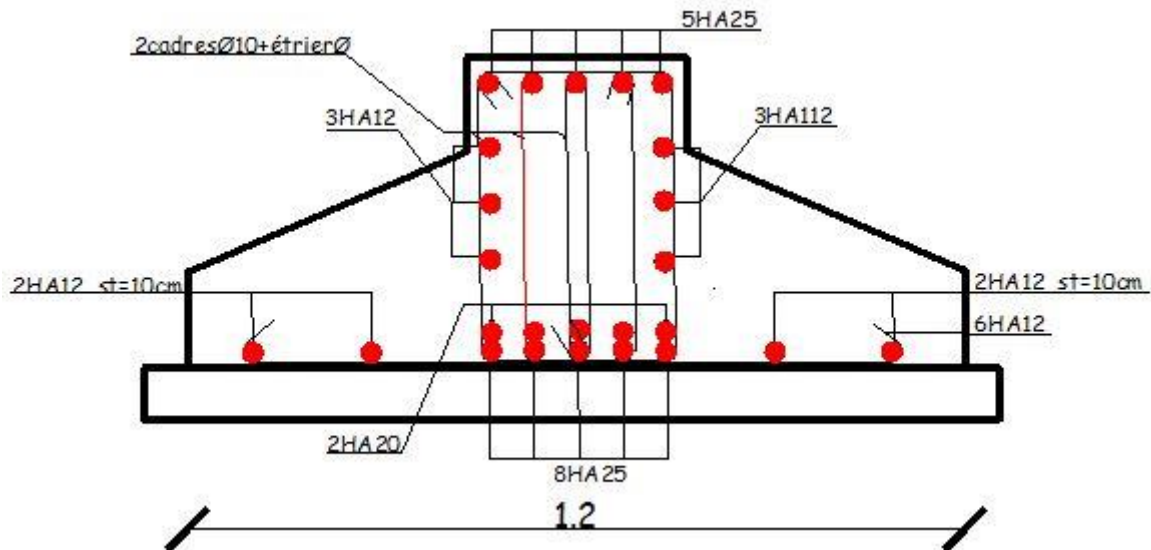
schéma de ferrailage de la semelle filante en appui (coupe transversale A-A').
